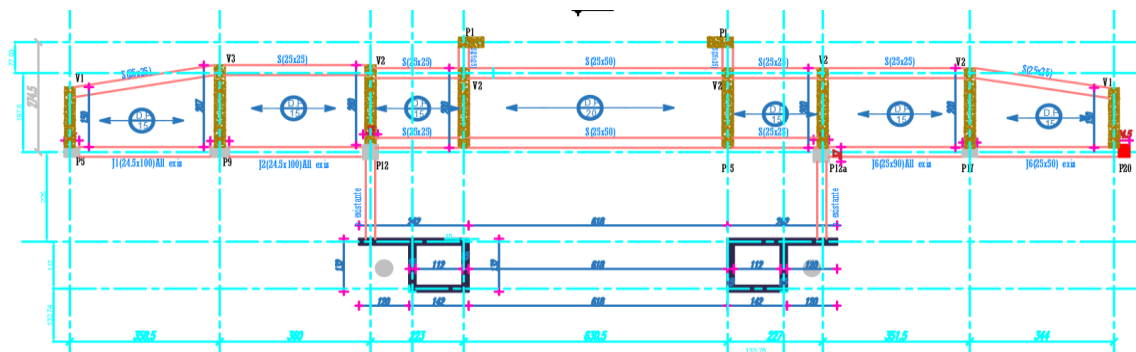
Vue en plan du PH 1er étage de la façade renforcé en béton armé
